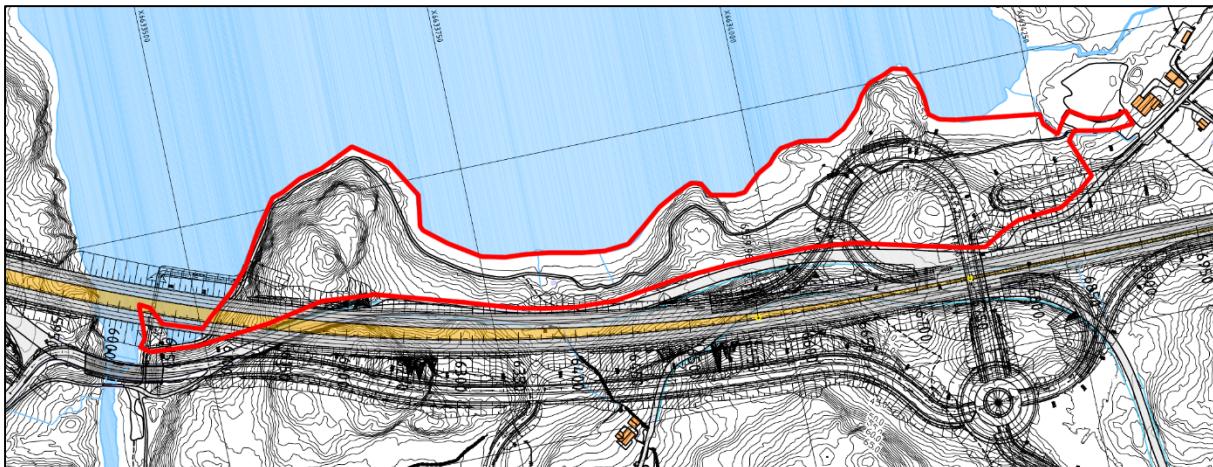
Alternativ 5, planlagt løysing Landåsvatnet – Ådland/Nordre Tveita
